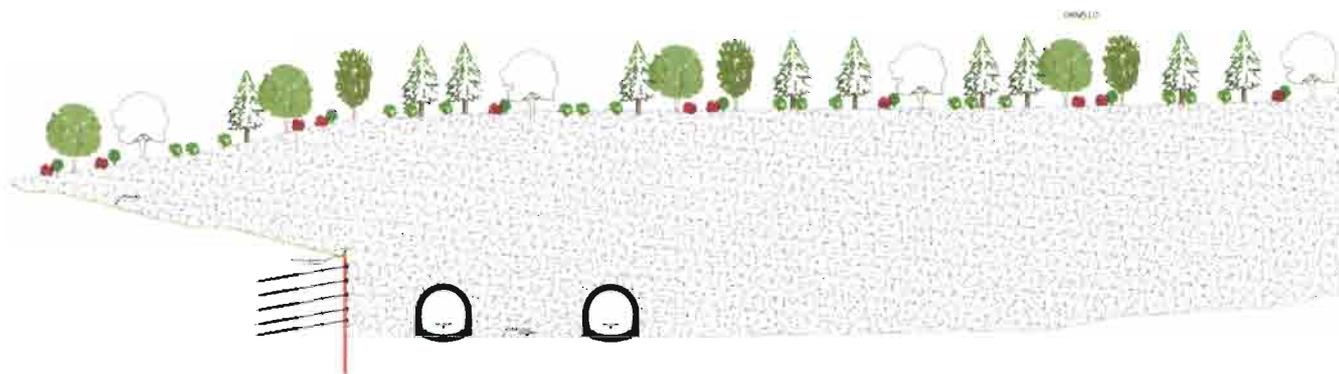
Sezione B–B'della planimetria opere a verde in corrispondenza del deposito definitivo Forch.
